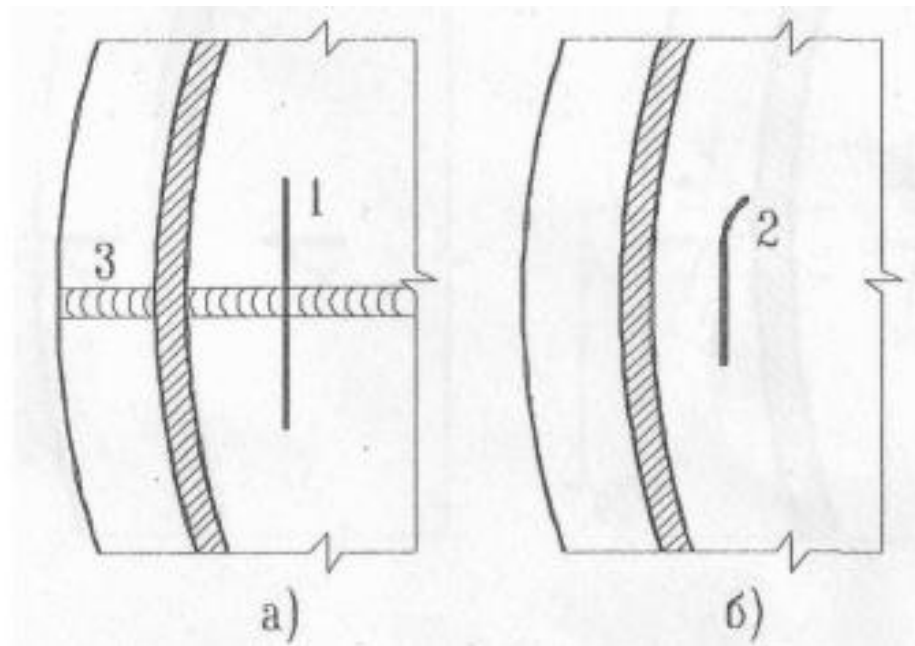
Поперечные трещины: а) трещина сварного соединения, распространившаяся на основной металл; б) трещина по основному металлу; 1,2 – трещины; 3 – сварной шов листов окрайки
